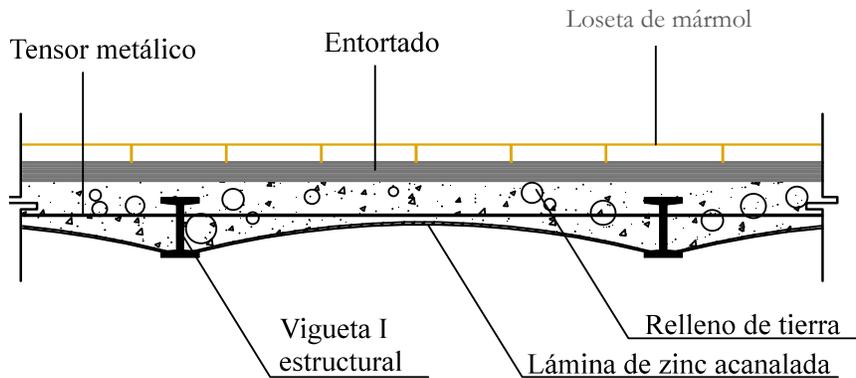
Detalle del entrepiso con lámina acanalada y vigueta. Fuente: EGR.
